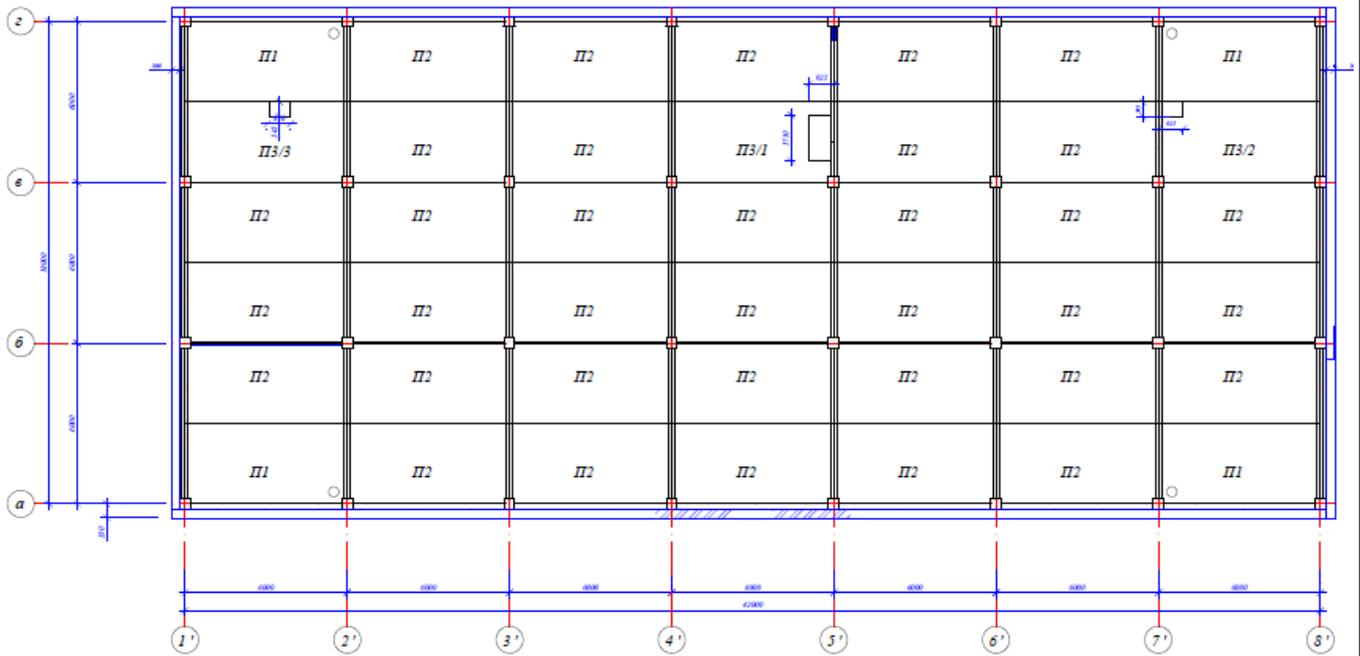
Схема розміщення плит покриття на відм.+6,600
